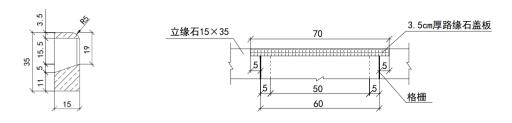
15×35 石质立缘石截面图与 A-A 断面图(单位: cm)
